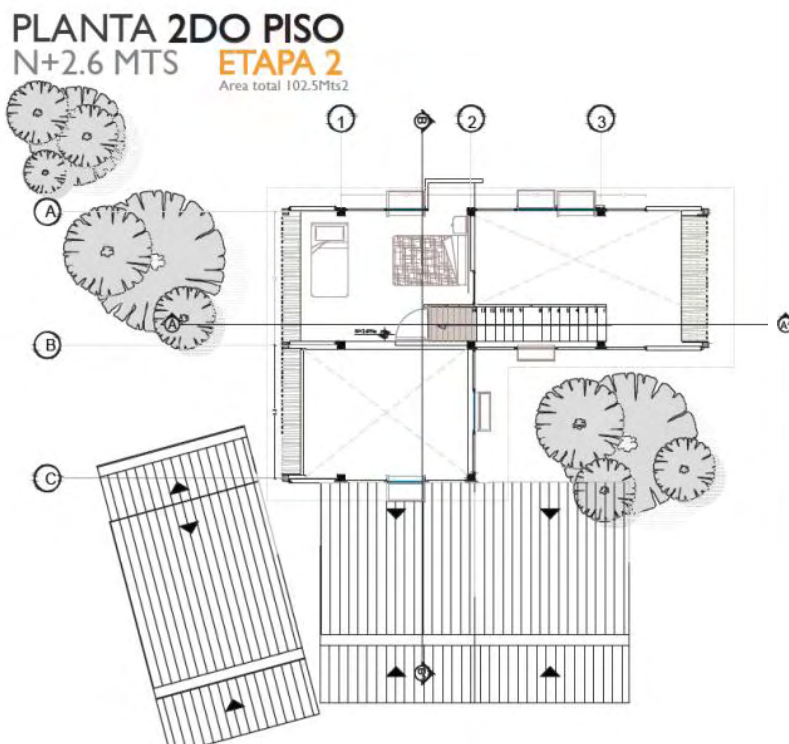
Planta 2 piso, Segunda etapa viviendaA2 Fuente: propia
